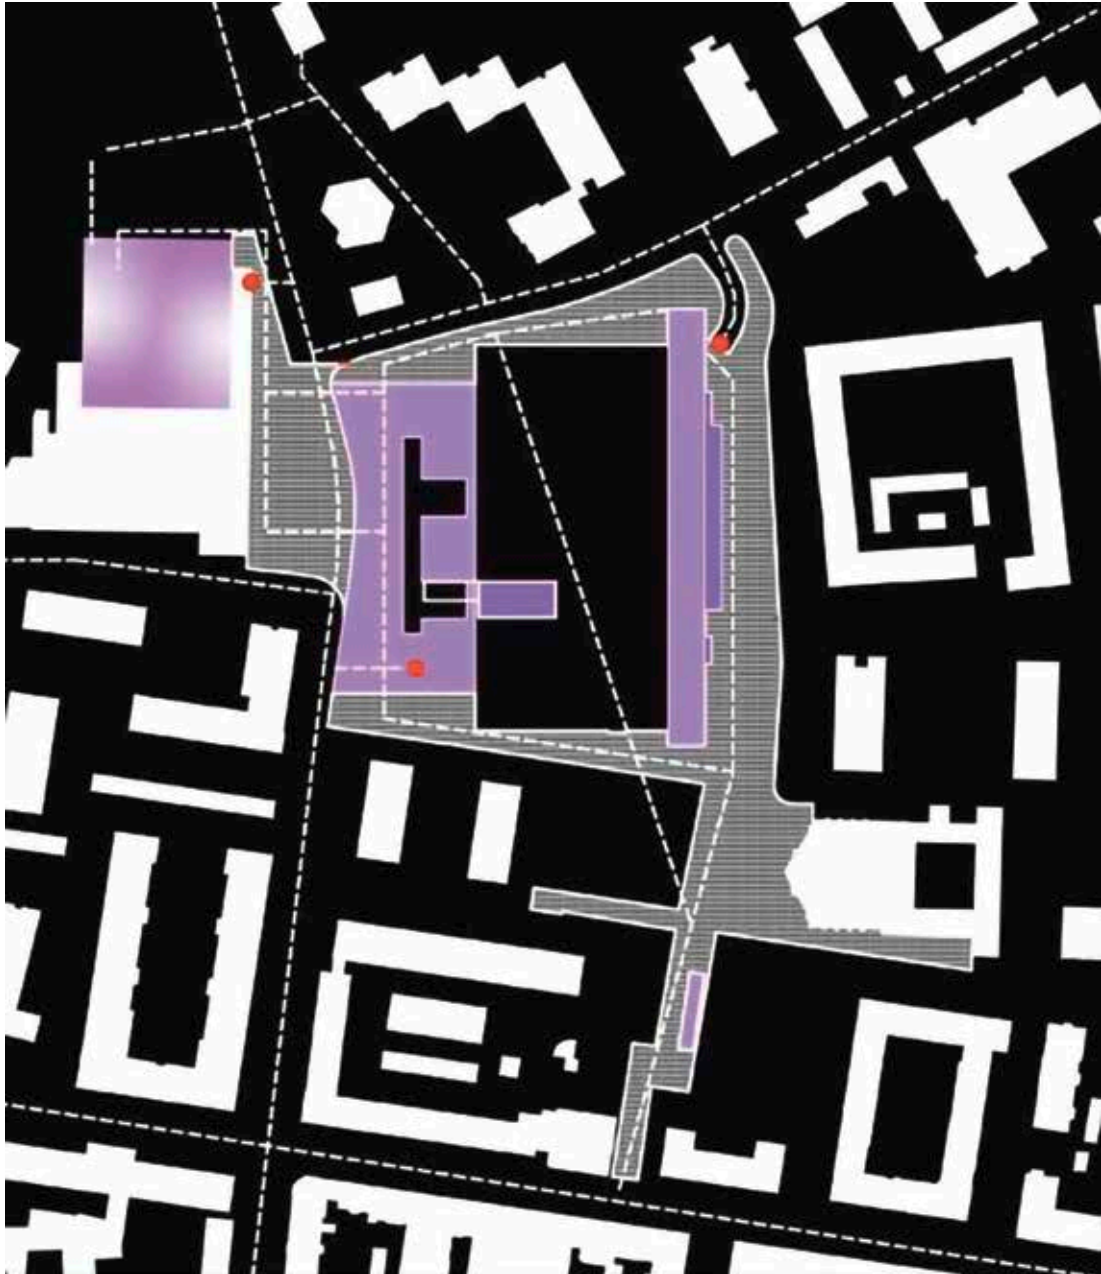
Projekt Neue Mitte Lehen – Lageplan
